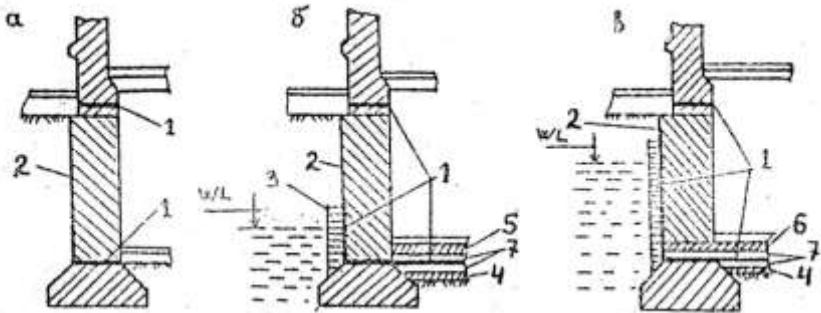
Гидроизоляция подвальных помещений: а – при уровне подземных вод ниже пола подвала; б – при уровне подземных вод выше пола подвала; в – в то же, при высоком стоянии; 1 – рулонная гидроизоляция; 2 – обмазка битумом за два раза; 3 – прижимная стенка; 4 – бетонная подготовка; 5 – пригрузочный бетон; 6 – железобетонная плита; 7 – цементная стяжка.
